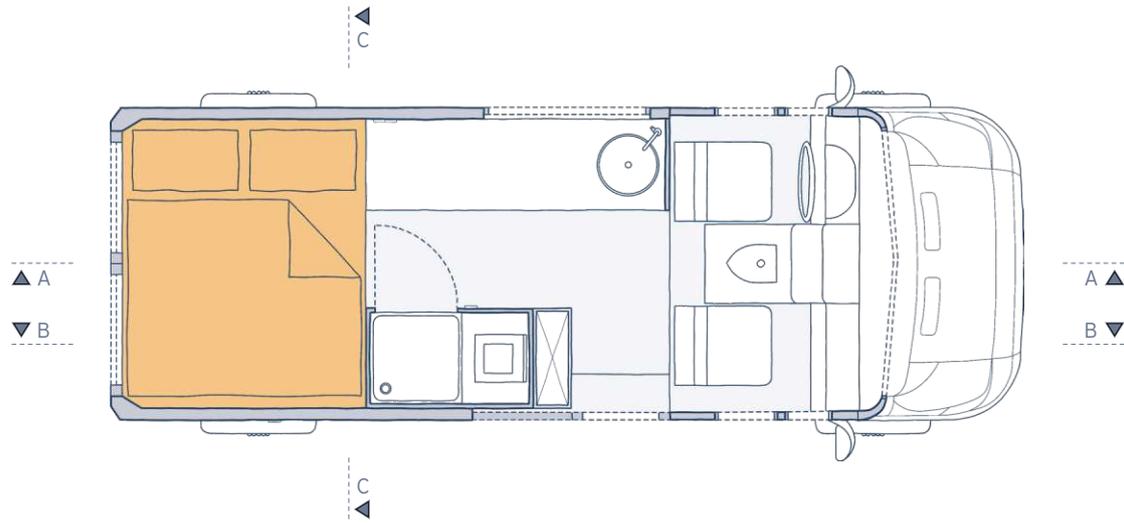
Campervan für zwei Personen - Bett - Grundriss (Maßstab 1:50)
